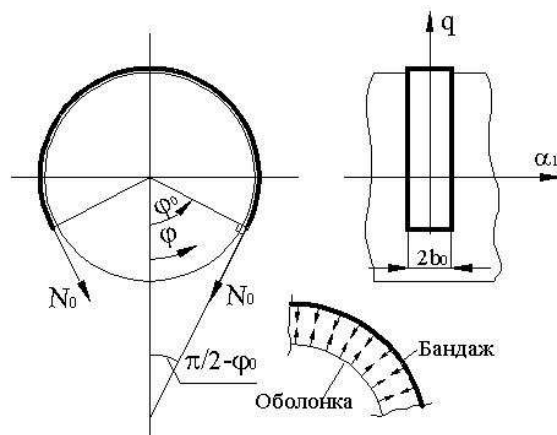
Розрахункова схема взаємодії циліндричного резервуара із гнучким бандажем
